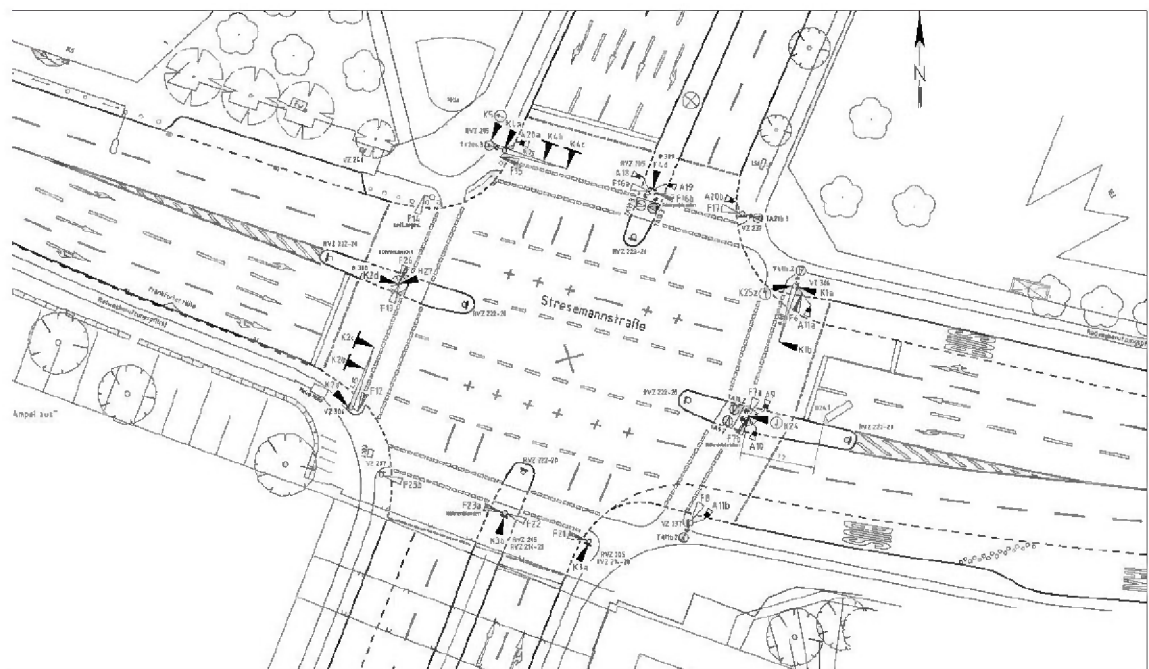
Signallageplan Stresemannstraße/Alsenstraße – Bestand (03/153-04-03/07)
